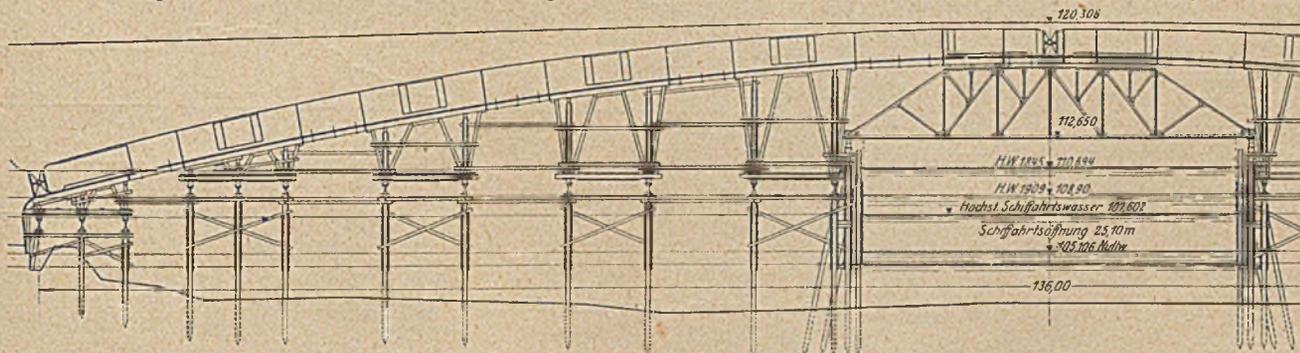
Entwurf Elbbrücke Dresden. Lehrgerüst des Hauptbogens von 136 m Spannweite.
